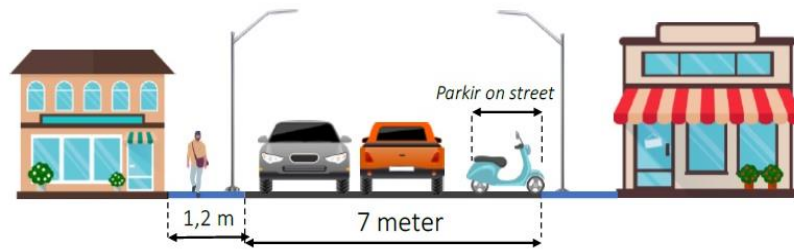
Foto Jalan May. Jend. Soetoyo segmen M
